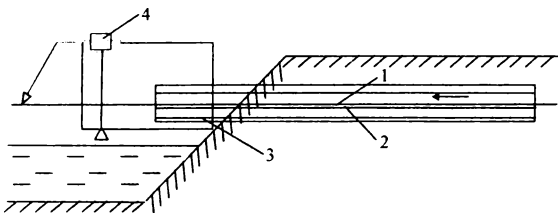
Схема водомерного устройства для устья закрытой дрены: 1 – дрена; 2 – навесной кожух; 3 – перфорация дрены; 4 – водоучитывающий прибор
